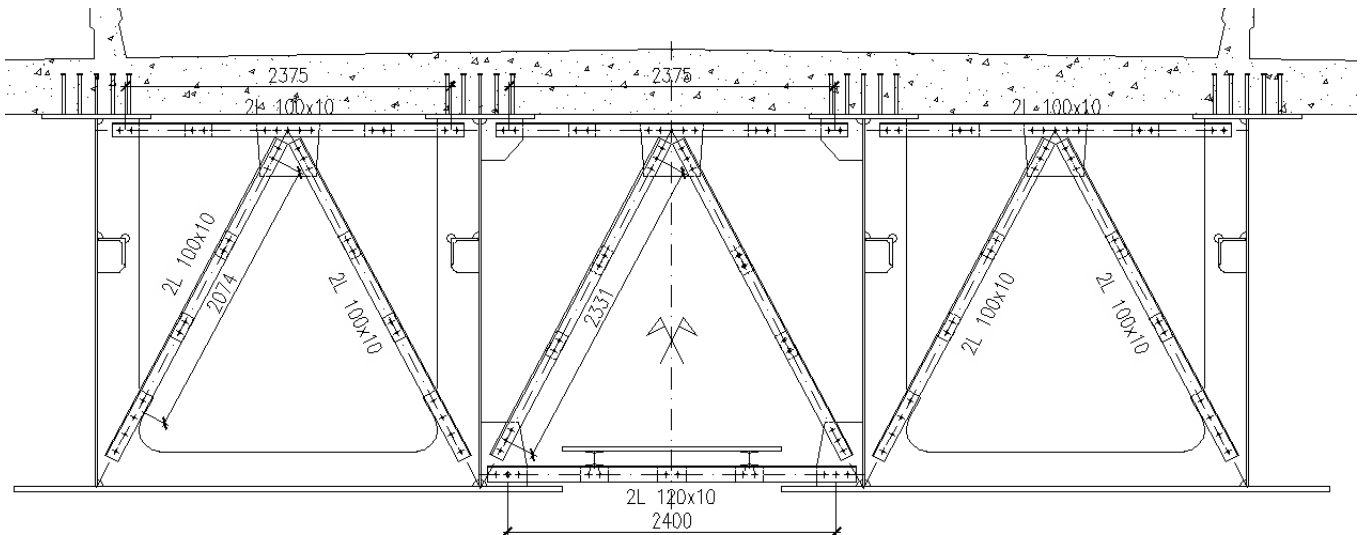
Sezione tipica: diaframma interno al cassone e diaframma di collegamento tra i cassoni (sezione tipica)
